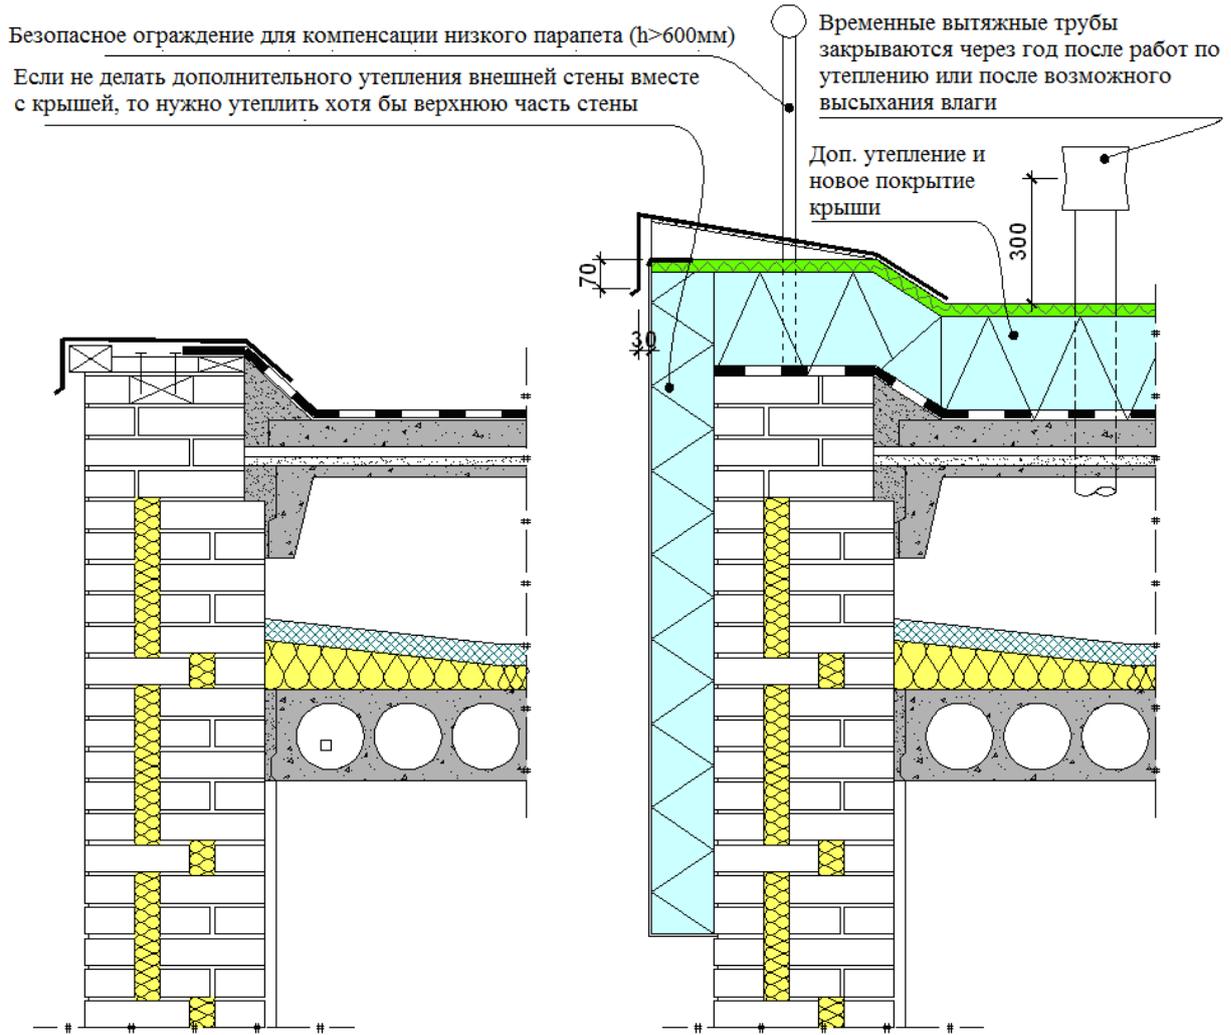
Основная схема утепления места соединения крыши и стены, где утепление угловой стены проходит в два этапа: слева положение до утепления, справа утепленный узел парапета.
